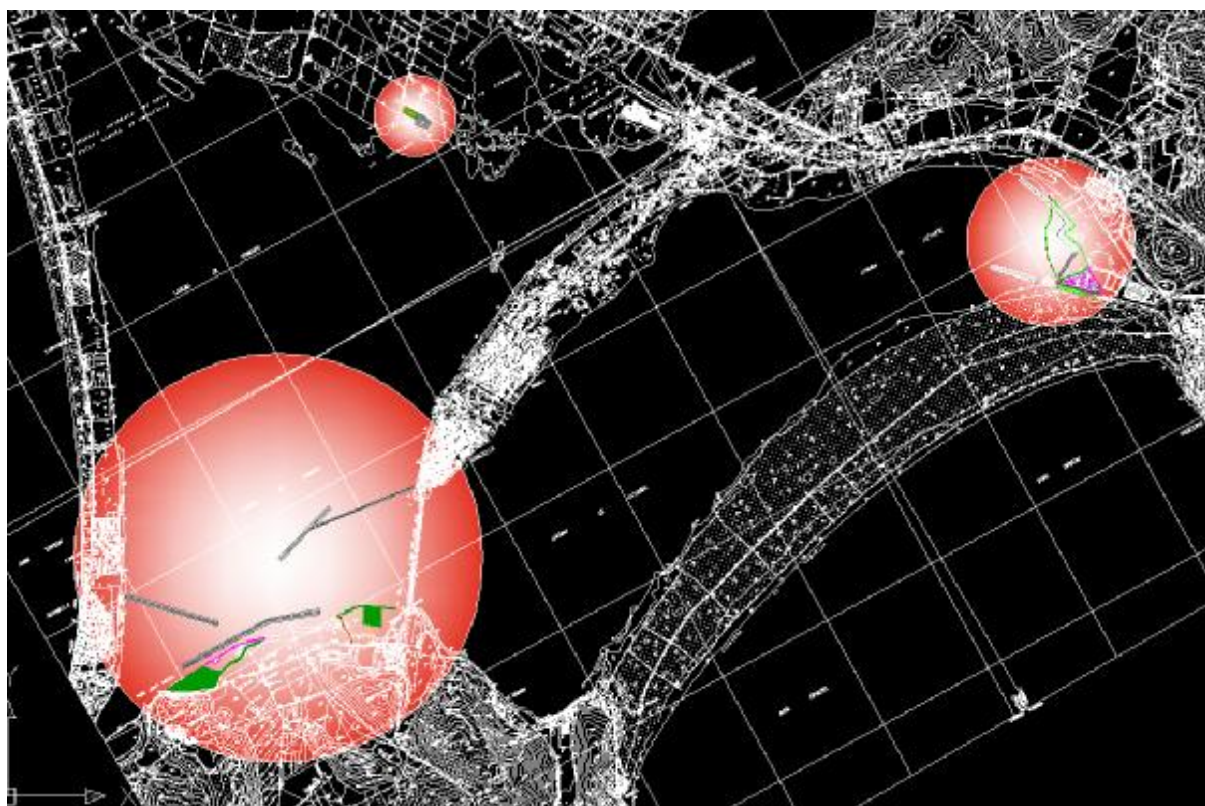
I siti lagunari oggetto di intervento dal punto di vista escavazione – formazione di casse di colmata
